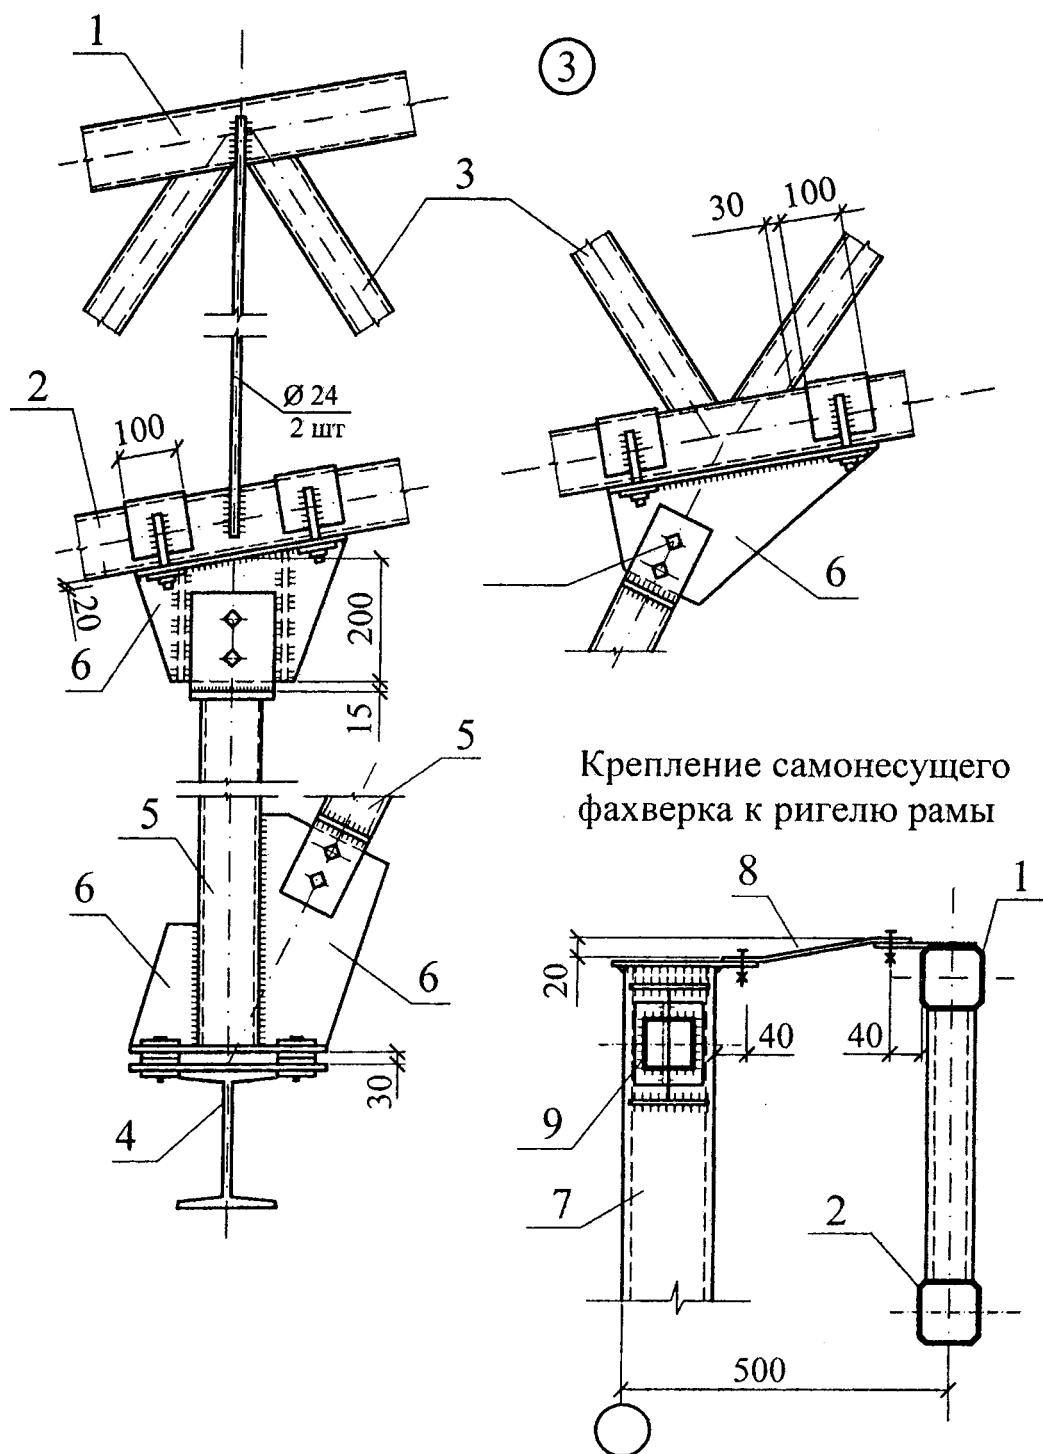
Узлы крепления балки подвесного пути и стойки фахверка к ригелю рамы:
